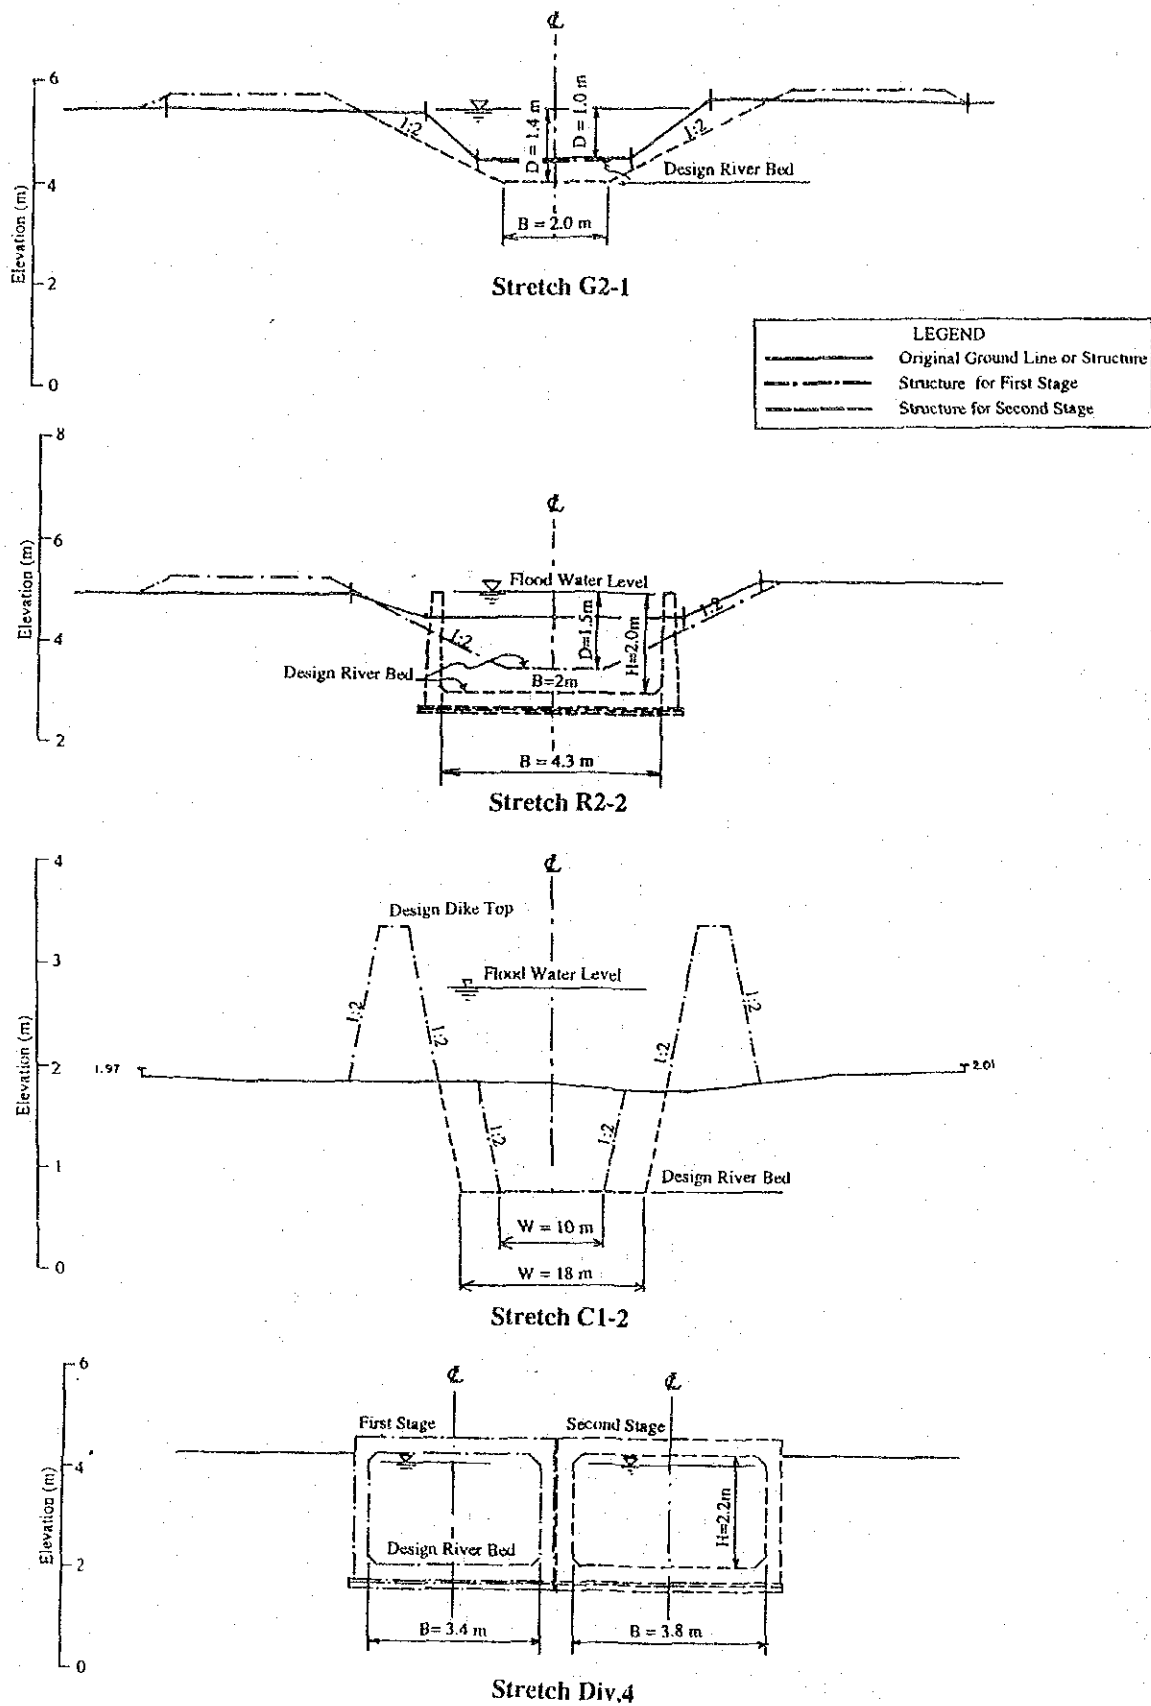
Profil en travers types des travaux d'aménagement (2/4)
